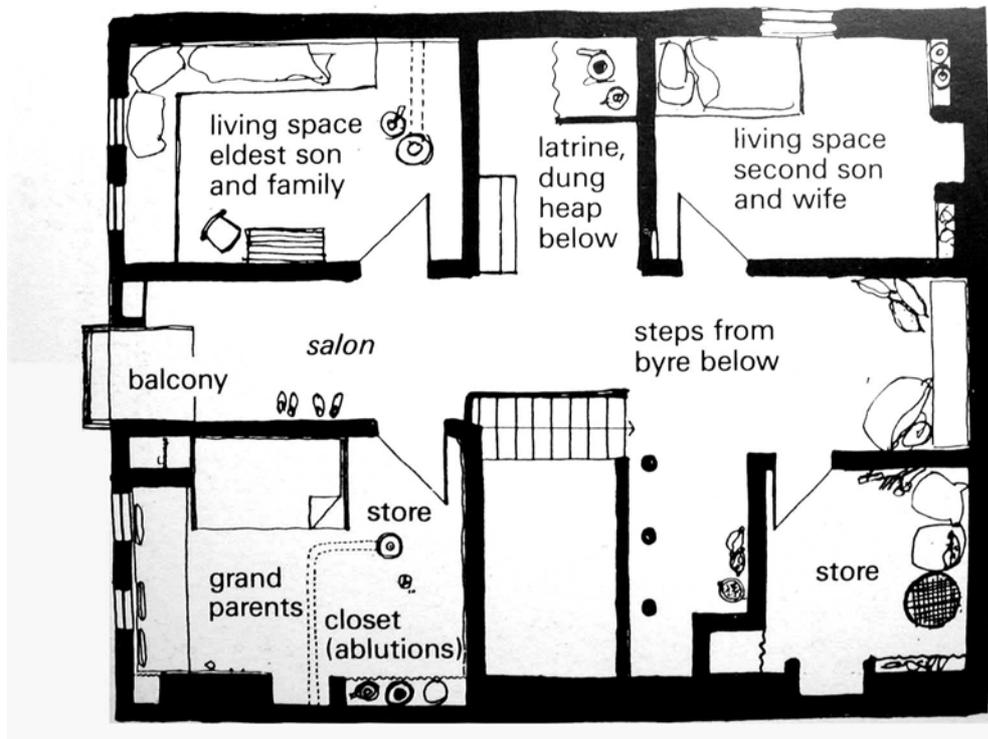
Grundriss eines Westanatolisches „Extended Family“ Hauses
